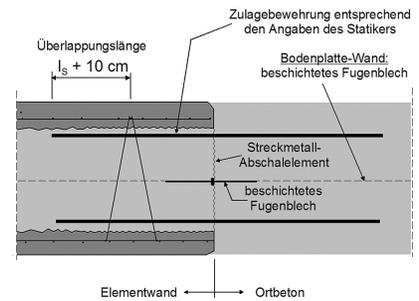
Biegesteifer Anschluss einer Elementwand an eine Ortbetonwand
